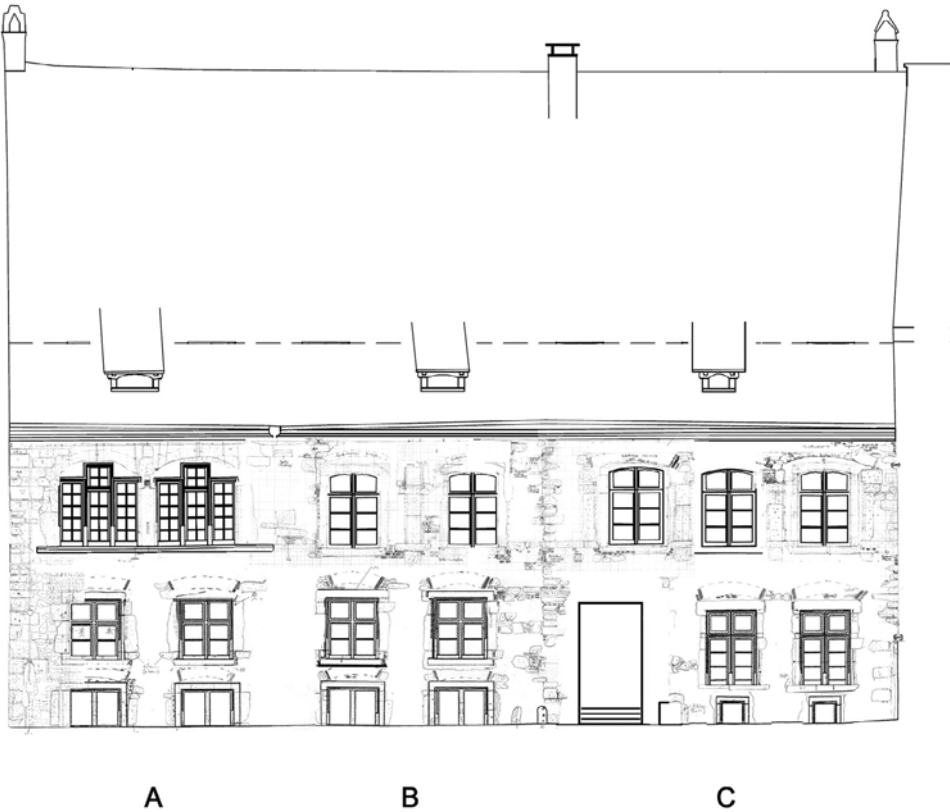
Freiburg, Historisches Kaufhaus – Rekonstruktion der Straßenfassade im 18. Jahrhundert. Plan: Frank Löbbbecke, 2010.
